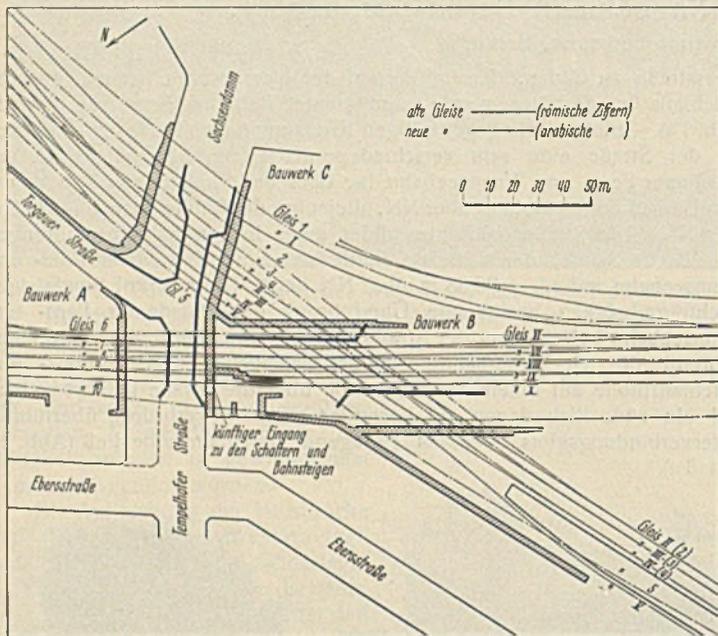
Lageplan. Alte und neue Gleise übereinandergezeichnet.
